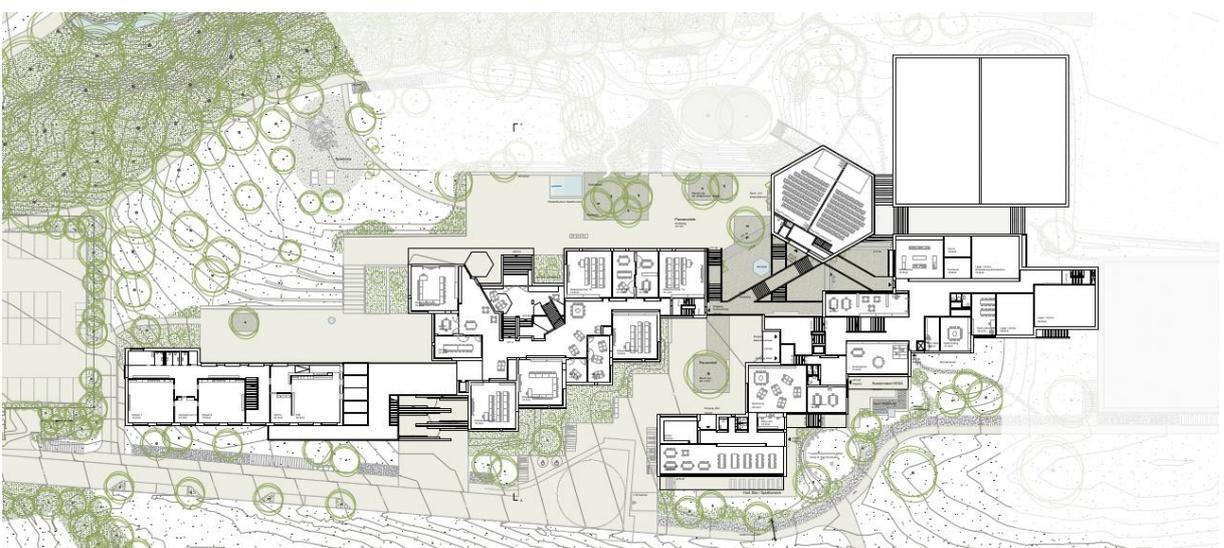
Grundriss Obergeschoss Primarschule / Erdgeschoss Sekundarschule / Singsaal
